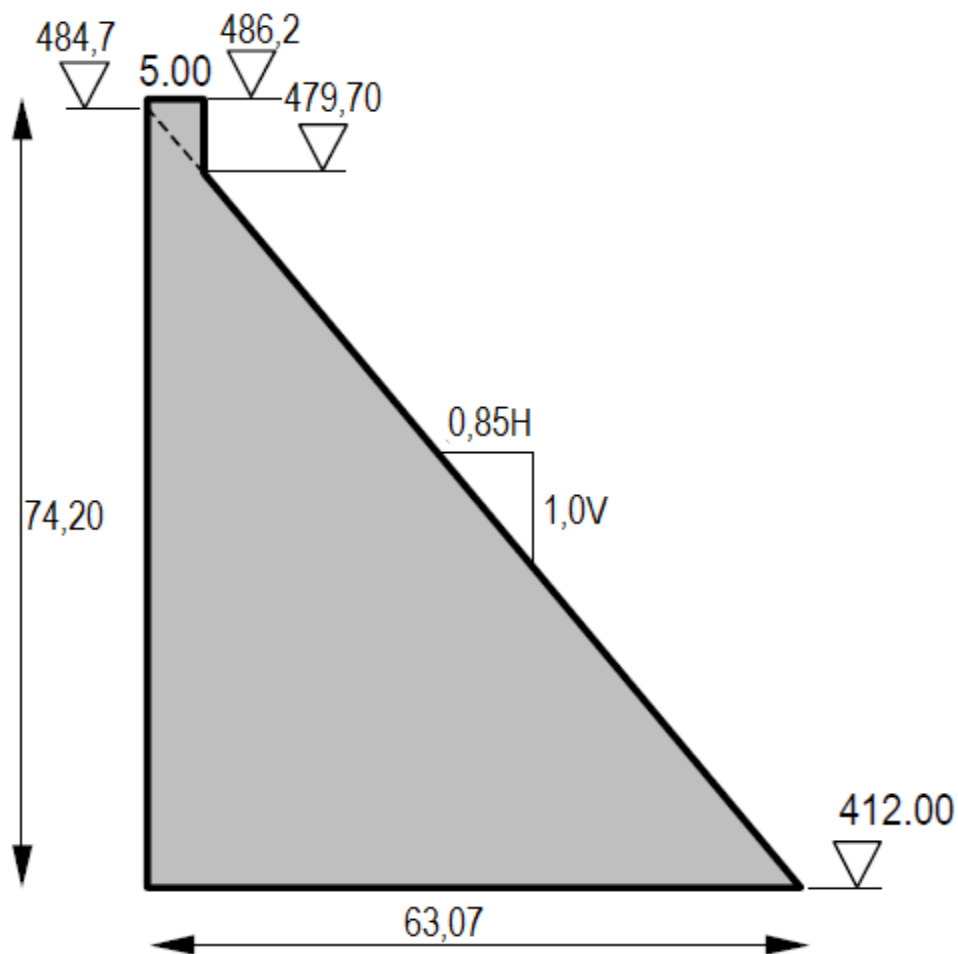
Section type non déversante du barrage Portes de Fer [en mètre]
